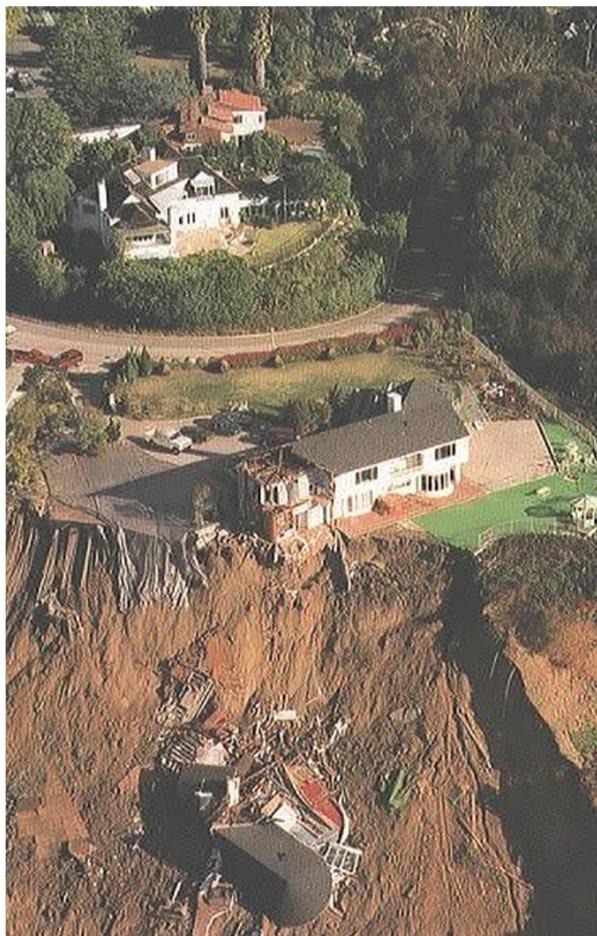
Потеря устойчивости склона под жилыми зданиями
